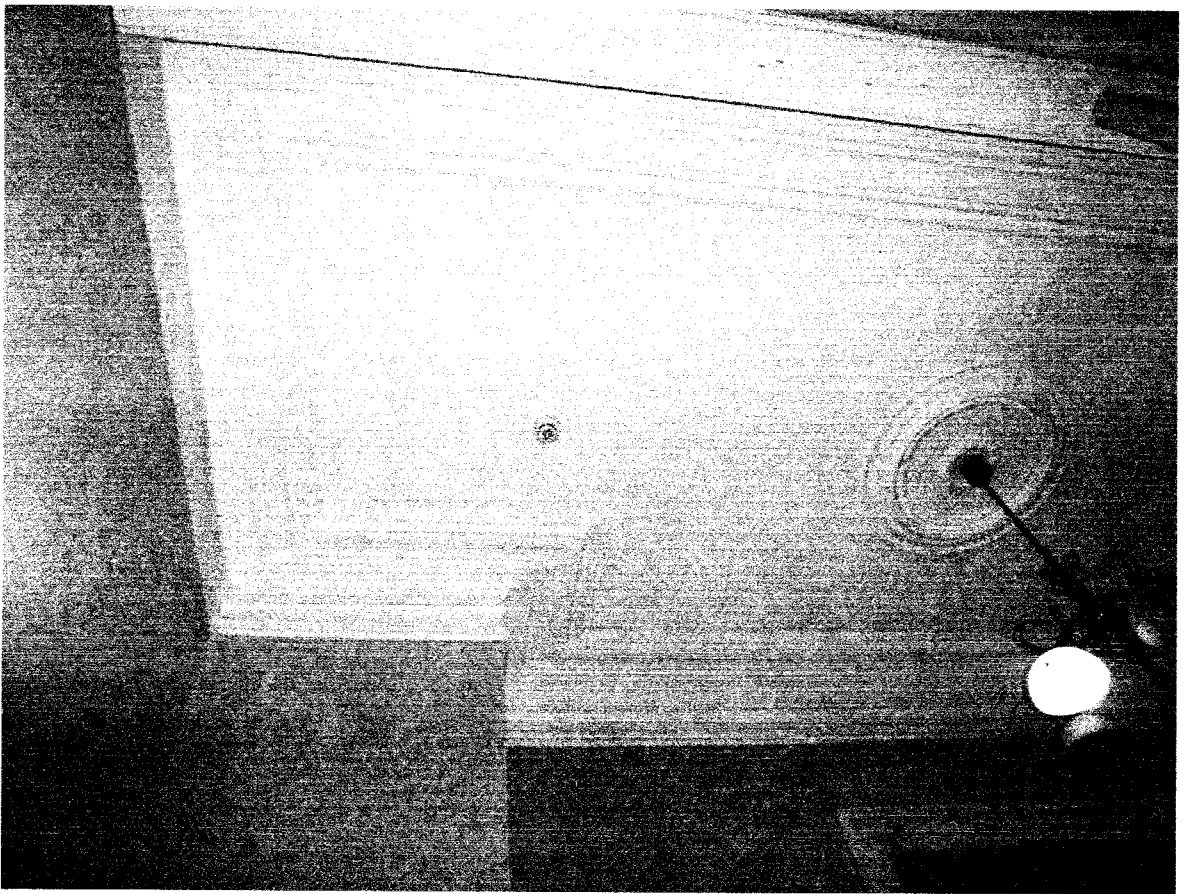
Первый этаж. Помещения 4, 5. Потолок
